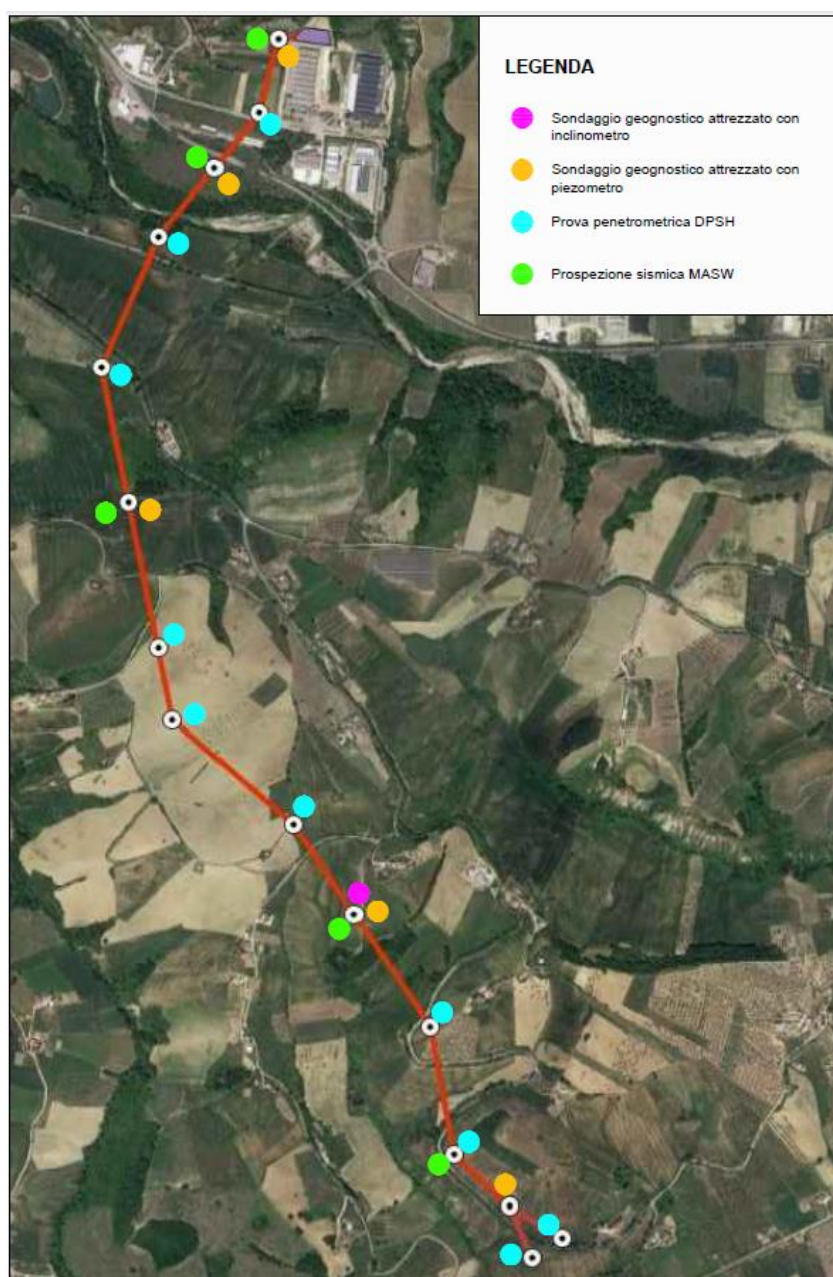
Stralcio planimetrico con l'ubicazione delle indagini.
